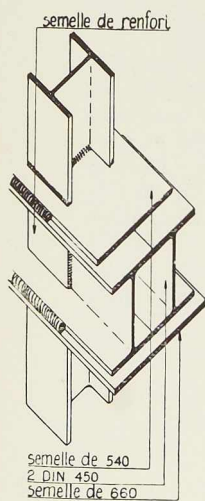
Type de montant oblique solidarissant les poutres transversales avec les poutres principales.
